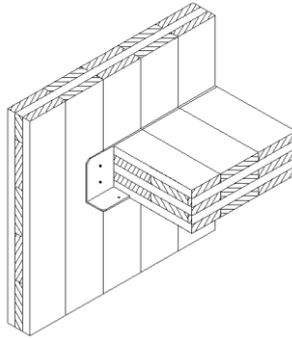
Appoggio del solaio di interpiano su parete continua: collegamento mediante angolare metallico avvitato alla parete
